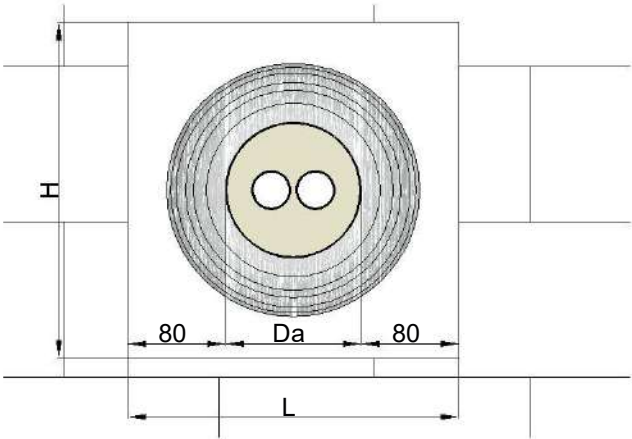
Wall breach FibreFlex/HeatFlex DUO
